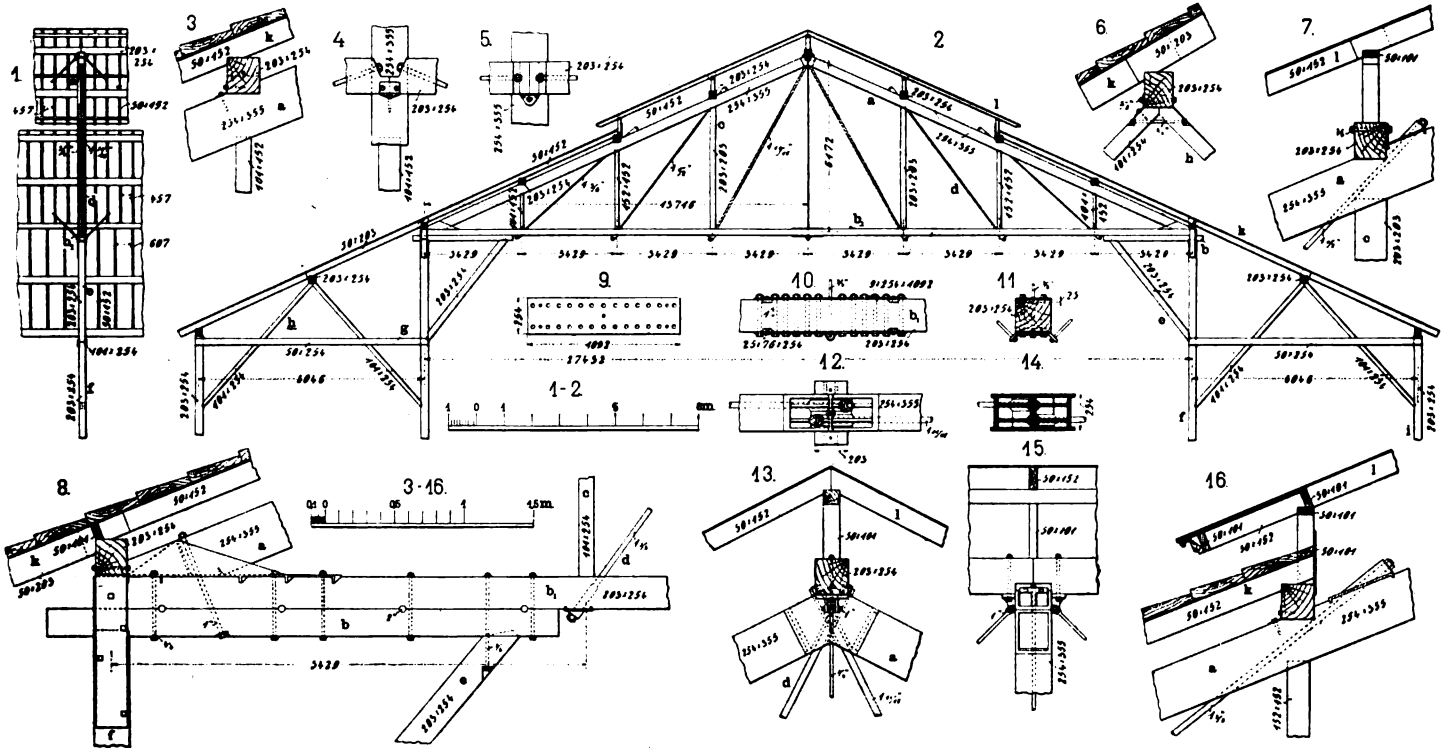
Die Dachkonstruktion des „Forestry Building“ auf der Pan-Amerikanischen Ausstellung zu Buffalo.
